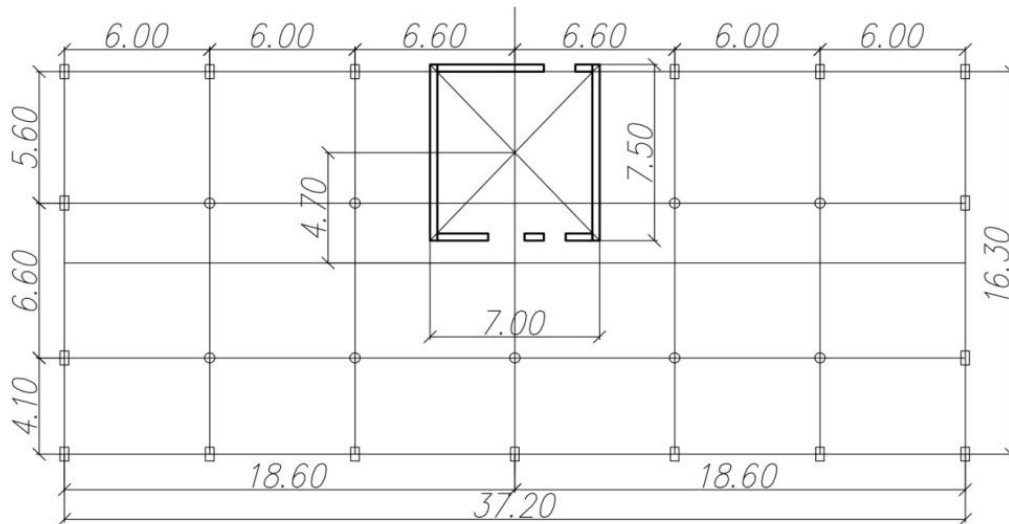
Розрахунковий (спрощений) план будівлі із ядром жорсткості
